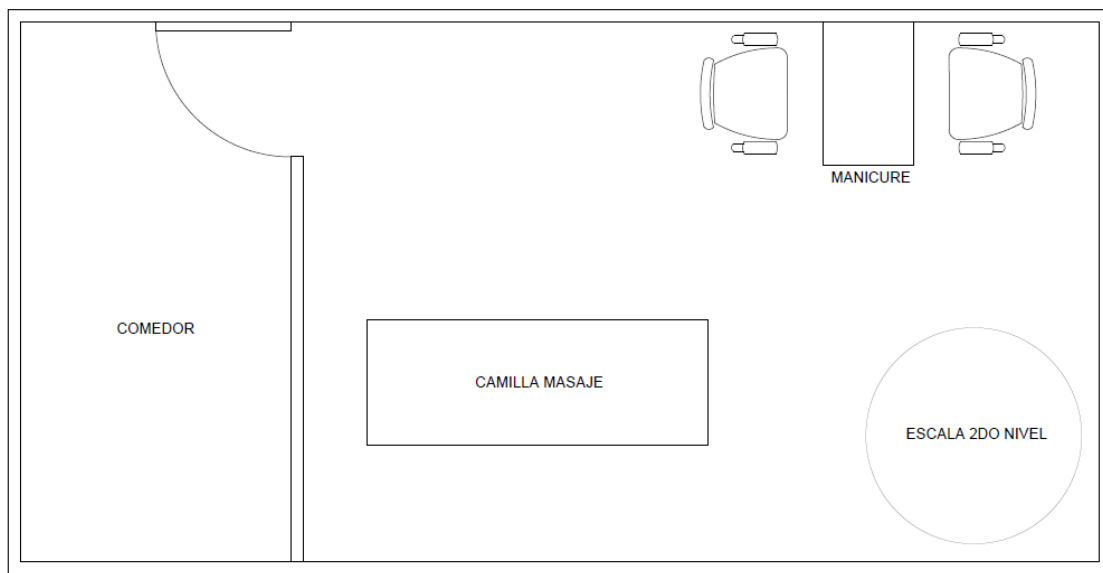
"Layout Segundo Piso Salón de Belleza (Fuente: Elaboración Propia)
